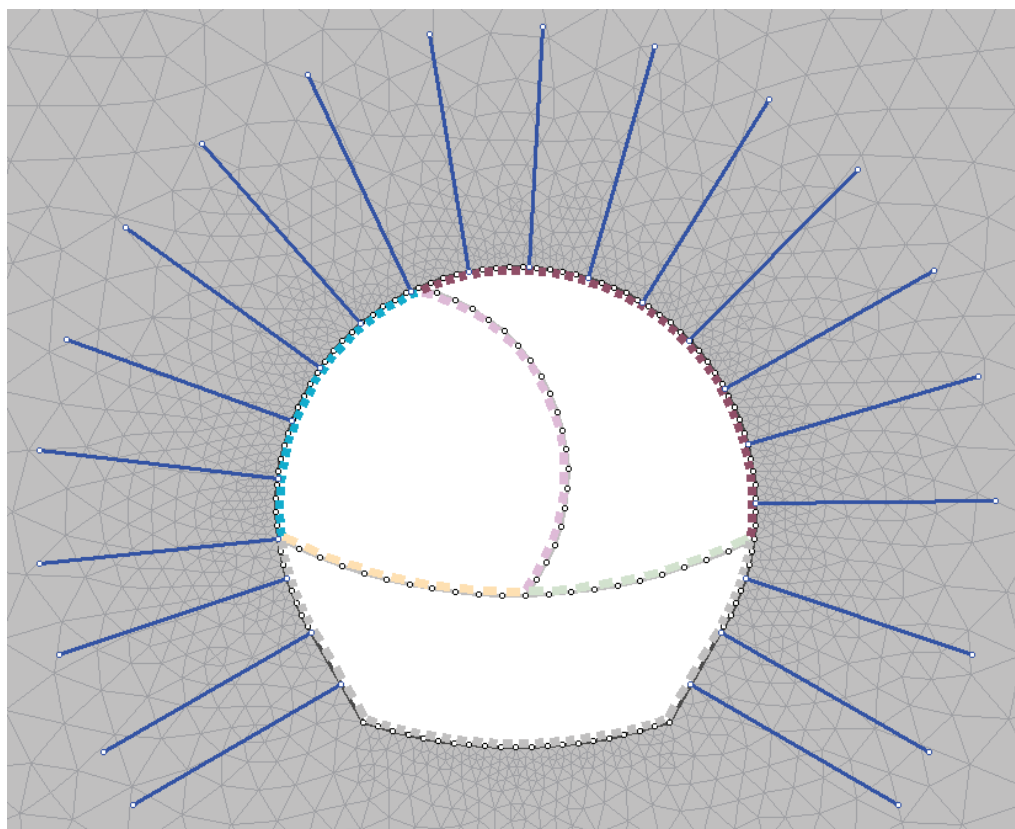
Terceira fase da escavação (escavação da soleira) e instalação do suporte primário (betão projectado e pregagens nos hasteais e betão projectado na soleira) para a escavação em três secções parciais (imagem do programa Phase2).
